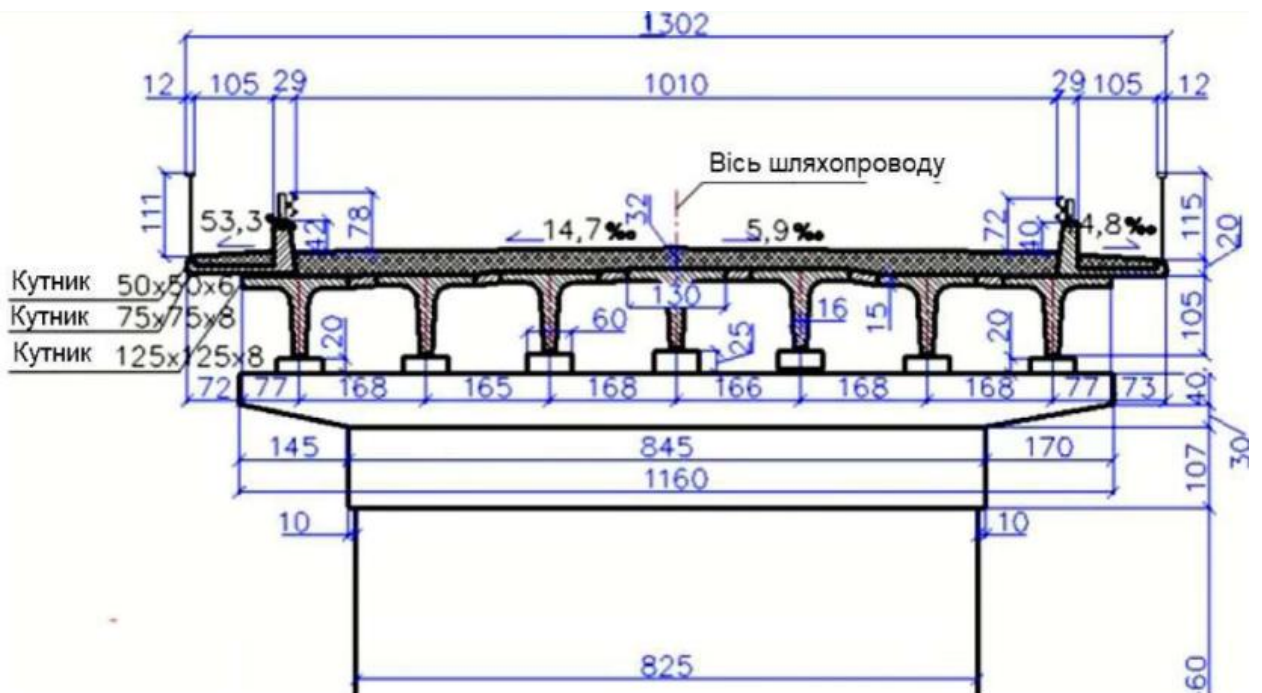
Поперечник залізобетонного шляхопроводу через залізничну дорогу
